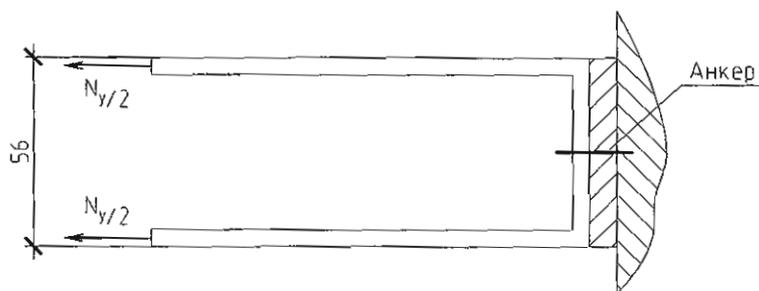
Схема работы кронштейна от ветровой нагрузки.
